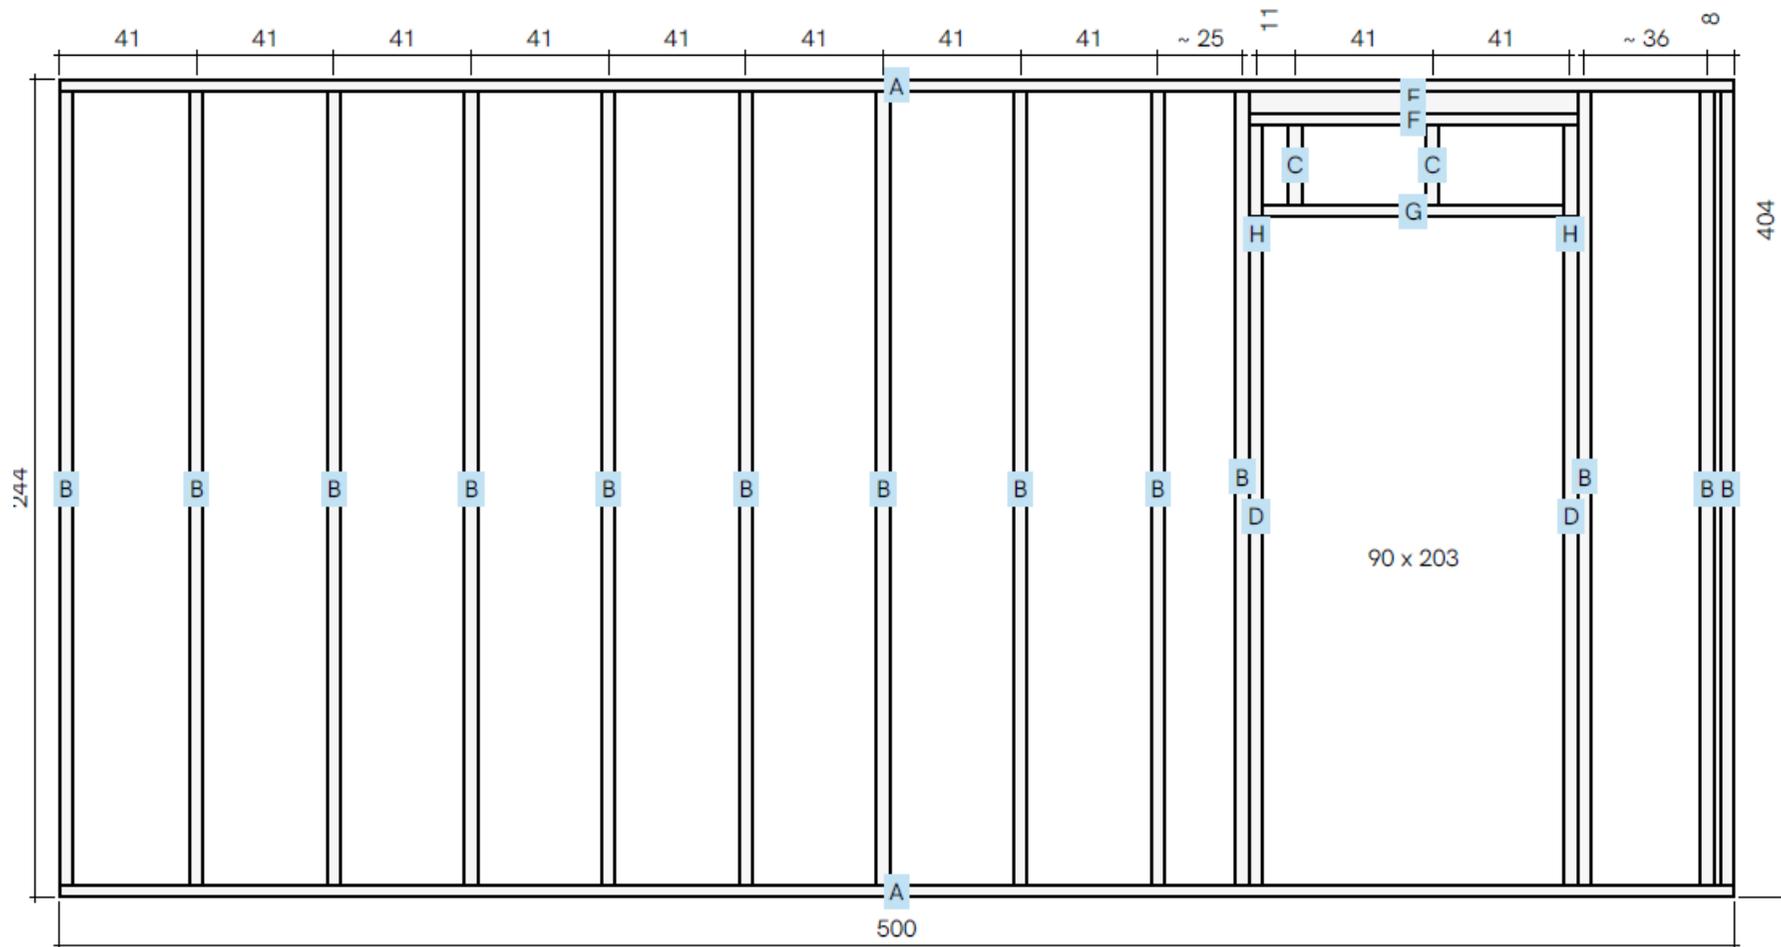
Andino, E. (2020)*. Diseño de paneles típicos para obra en Steel Frame, para ensamblaje o construcción en obra con detalle de vano de puerta. Elaboración propia.
